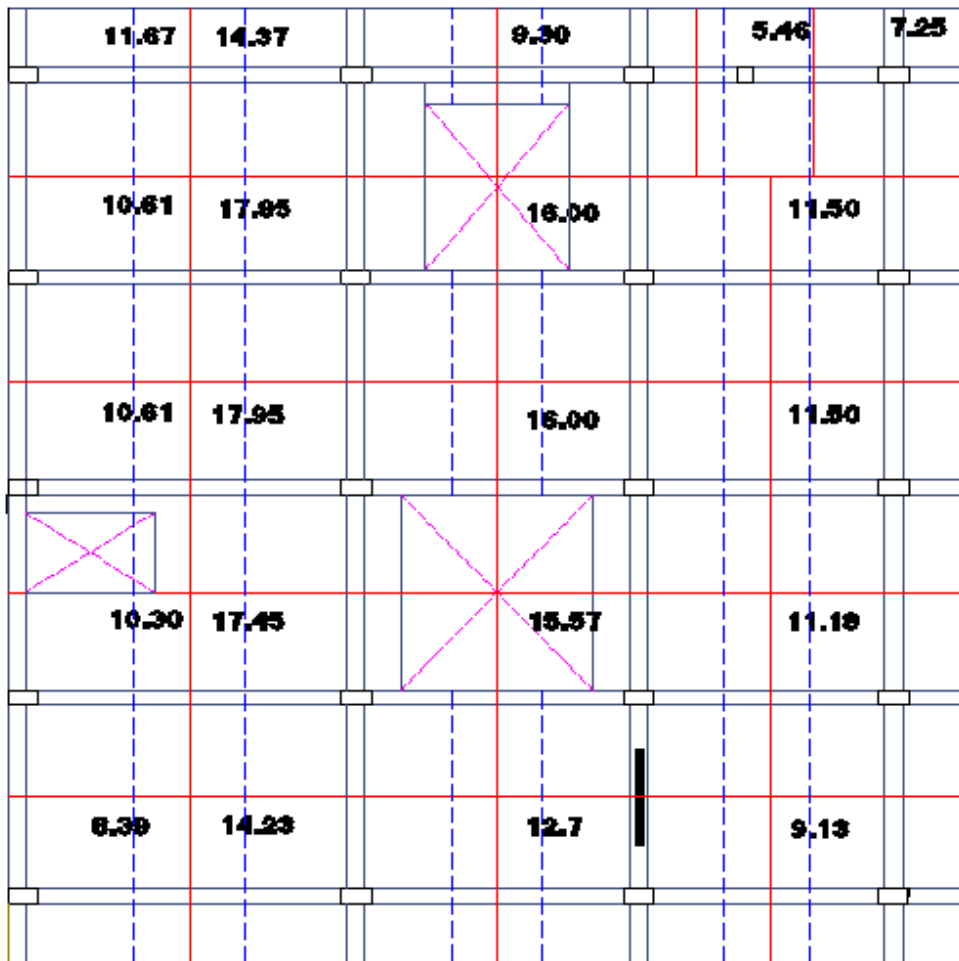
Ubicación en planta y área de tributaria de Columnas – 2 al 5 Piso.
